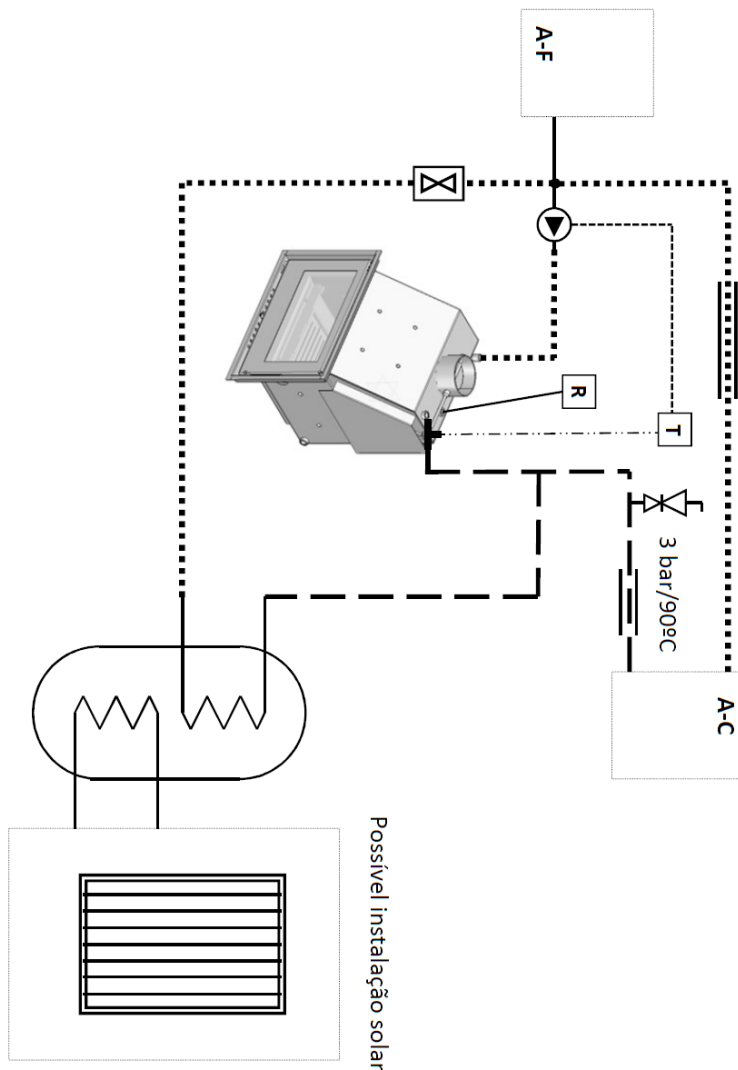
Esquema de Instalação para Aquecimento Central (AC) com Vaso de Expansão Aberto (AA) ou Fechado (AF).
